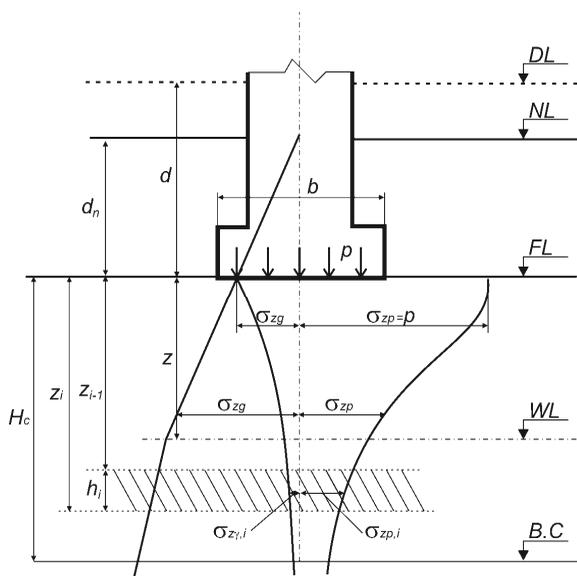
Расчетная схема к определению осадки фундаментов
